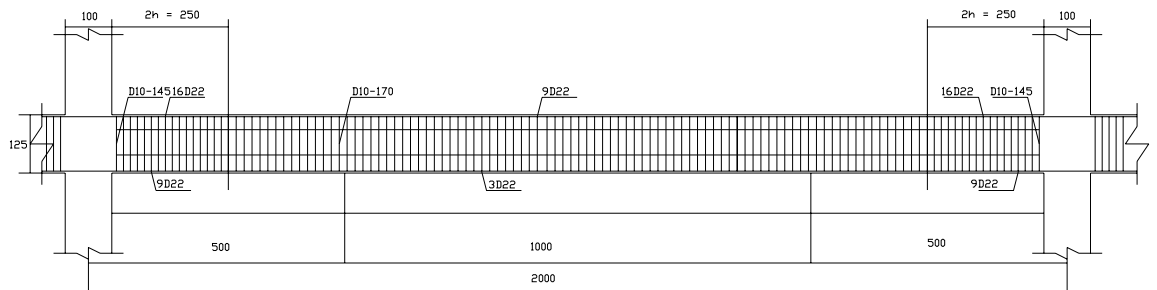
Detail penulangan balok induk 80/125 (cm) lantai 1 model
